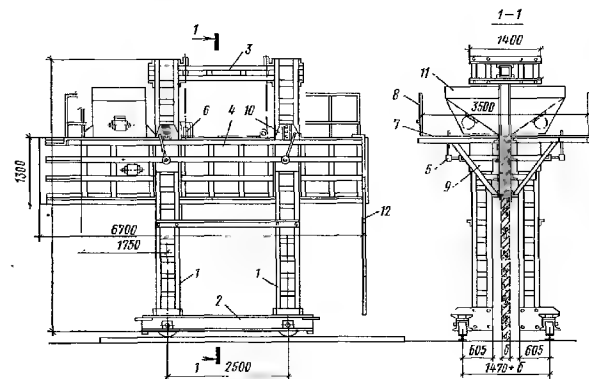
Схема катучей опалубки конструкции Донецкого Промстройинициативного проекта: 1 — колонны портала; 2 — тележка; 3 — балка; 4 — щит опалубки; 5 — прижимное устройство; 6 — лебедка подъема щитов; 7 — настель; 8 — ограждение; 9 — полузвон; 10 — фиксаторы; 11 — бункер; 12 — лестница
